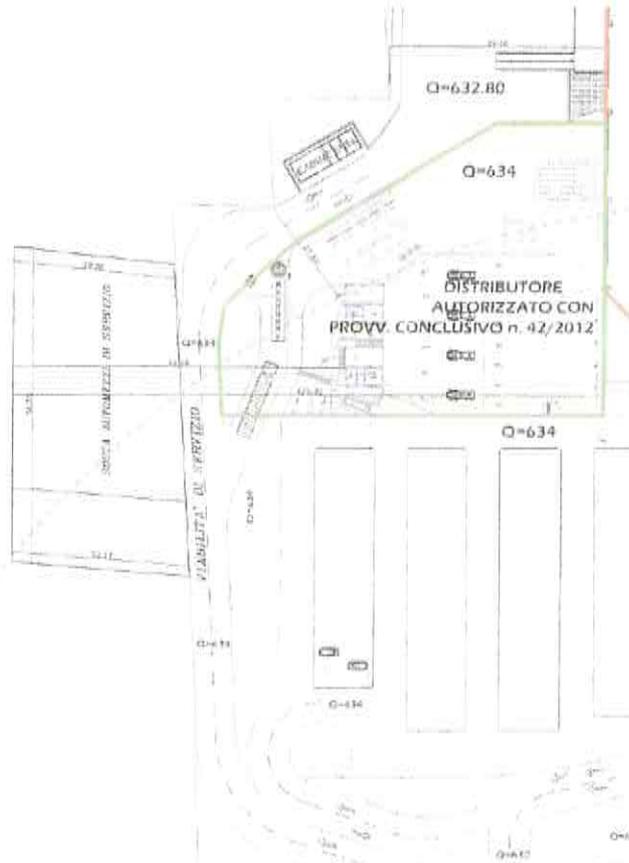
Particolare stato attuale (1V4 allegata al progetto)
